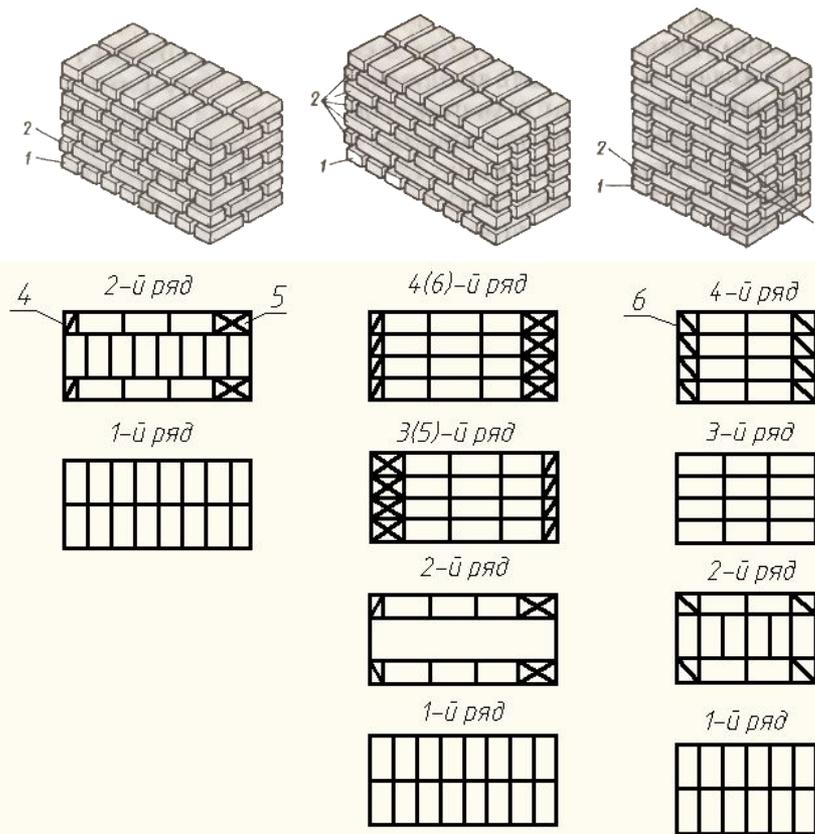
Системы перевязки при кладке стен 2 кирпича
